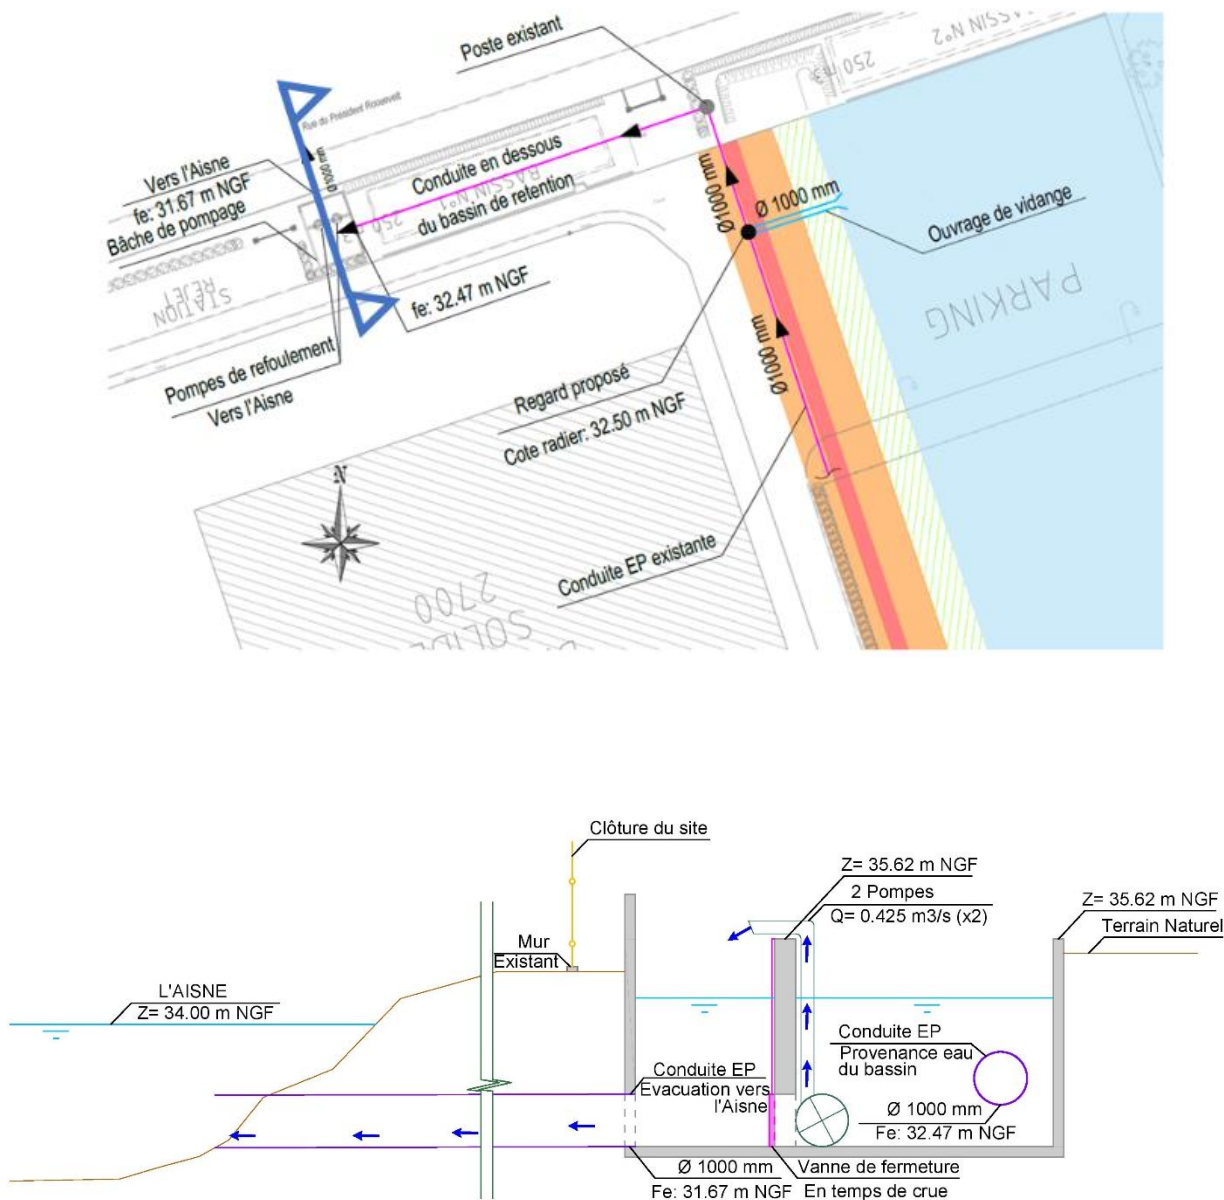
Vue en plan et coupe de la station de pompage de SANOFI
